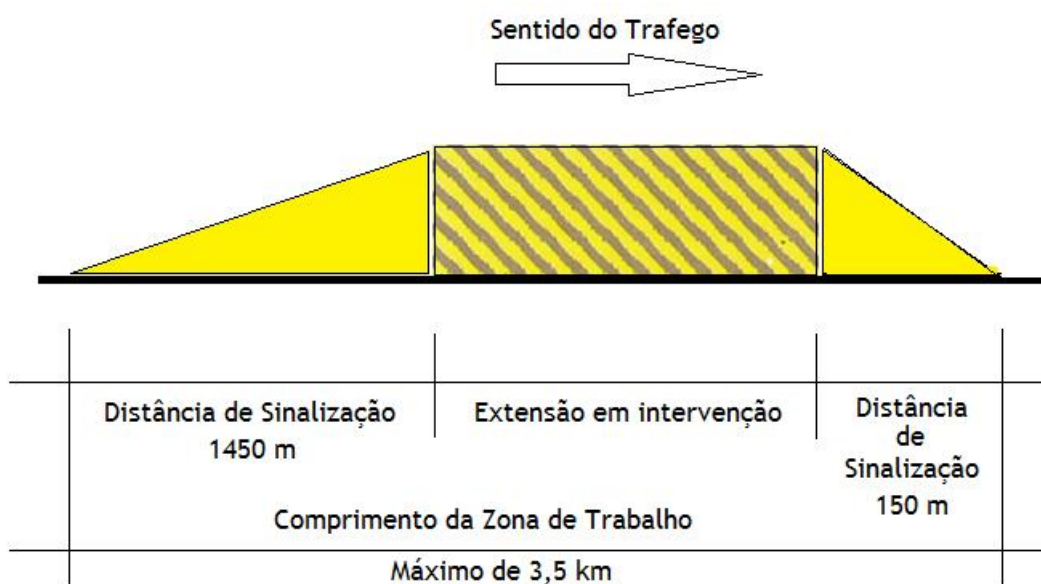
Definição do comprimento da "zona de trabalho" em planta.
